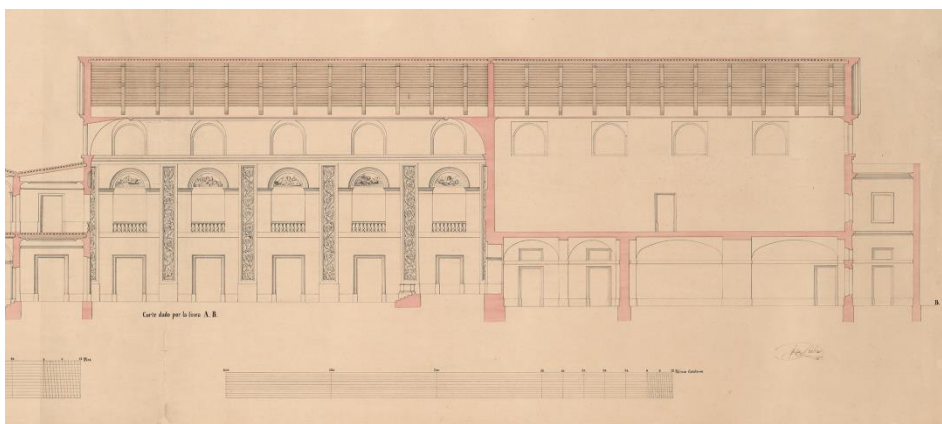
Sección longitudinal del Salón de Grados y la Biblioteca. Detalle de la fig. 8
